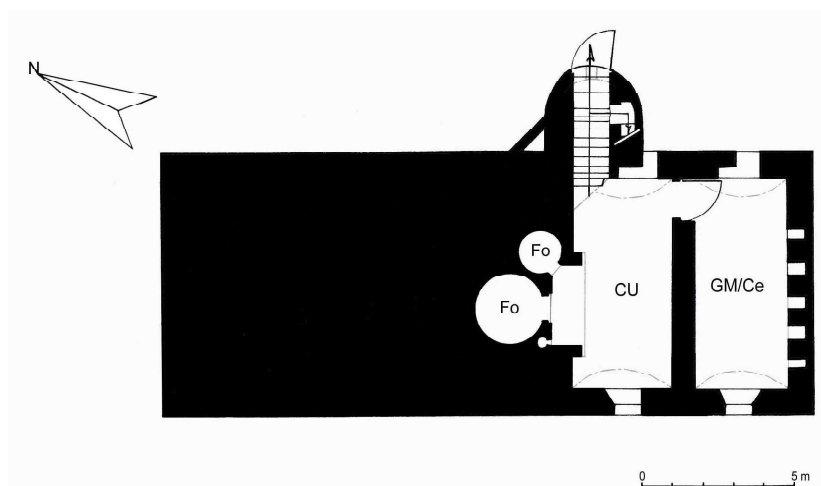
Mentheville. Plan restitué du sous-sol entre 1595 et 1606.
